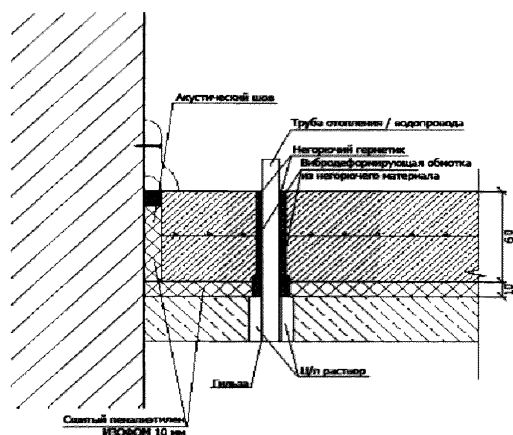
Узел прохода труб коммуникаций через перекрытие с конструкцией плавающего пола
